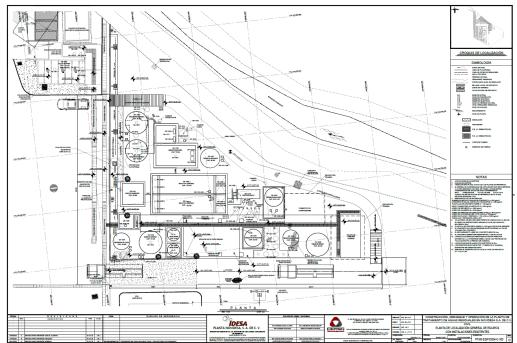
PLANO DE CONJUNTO DEL PROYECTO
